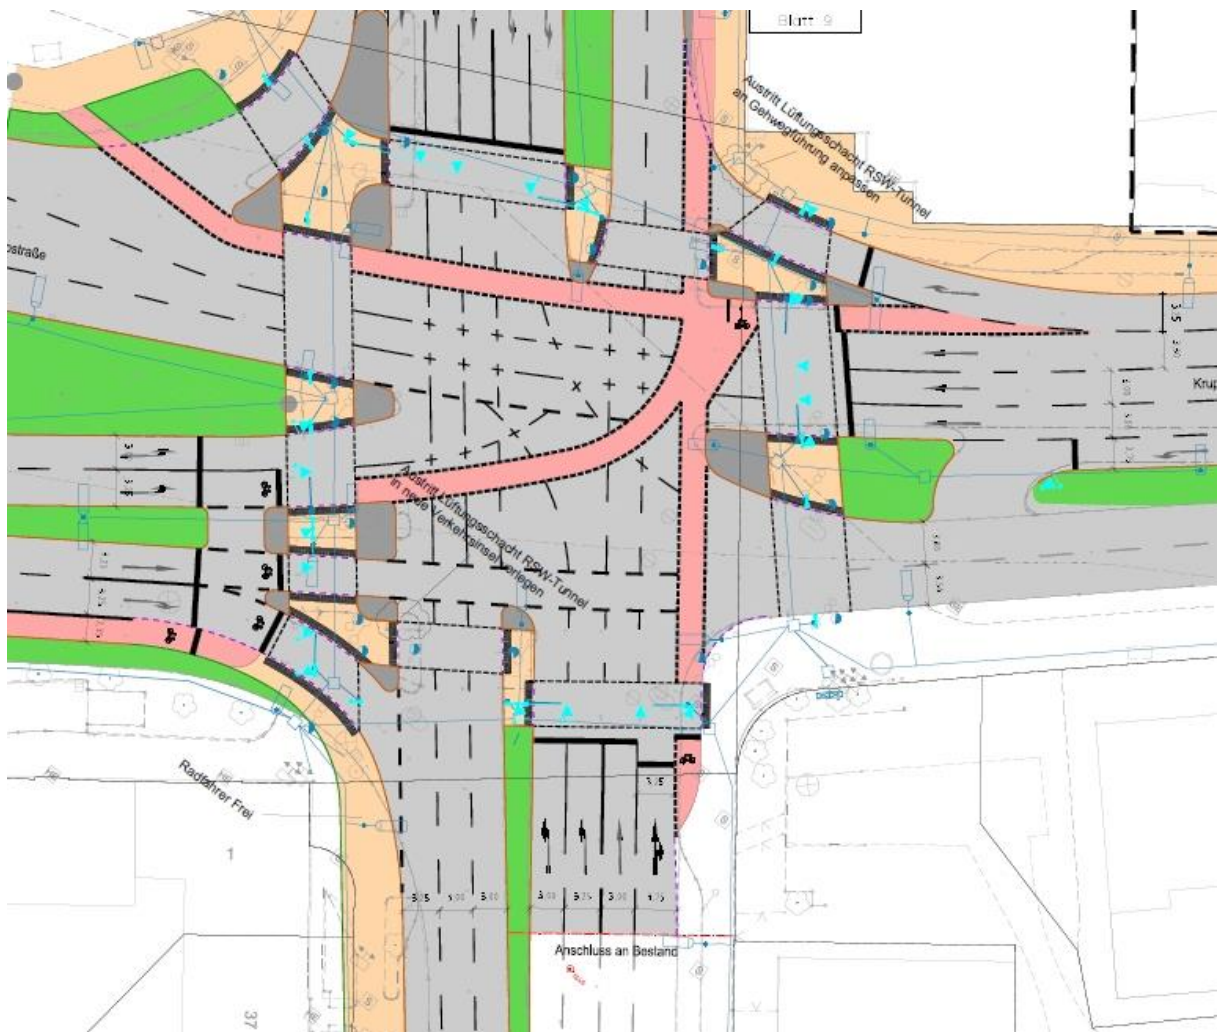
Lageplan Knoten Friedrichstraße / Kruppstraße / Holsterhauser Straße
